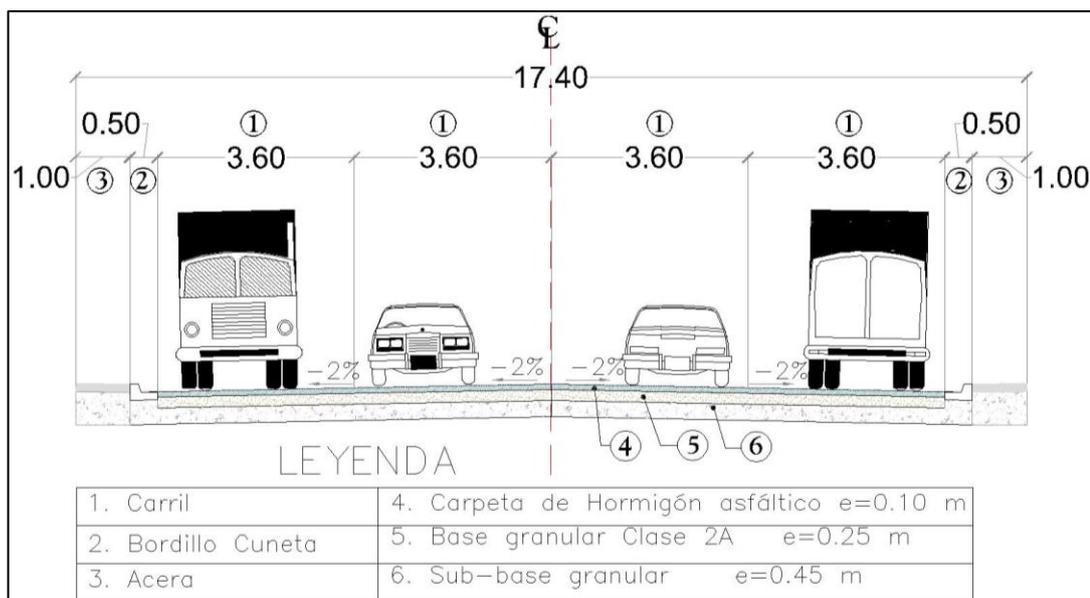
Sección Transversal para el tramo 2 de la alternativa 1.
